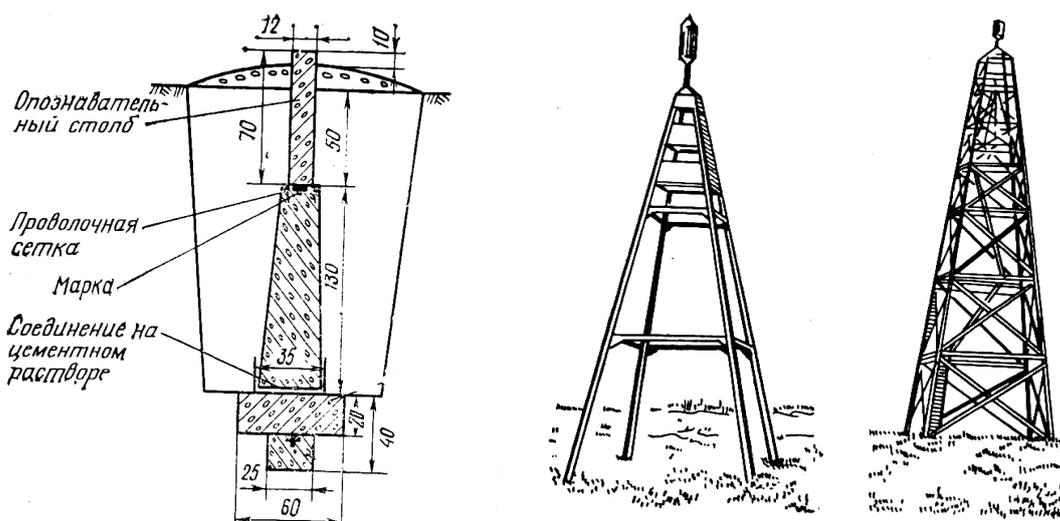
Схемы центра пирамиды и сигнала плановых государственных геодезических сетей
